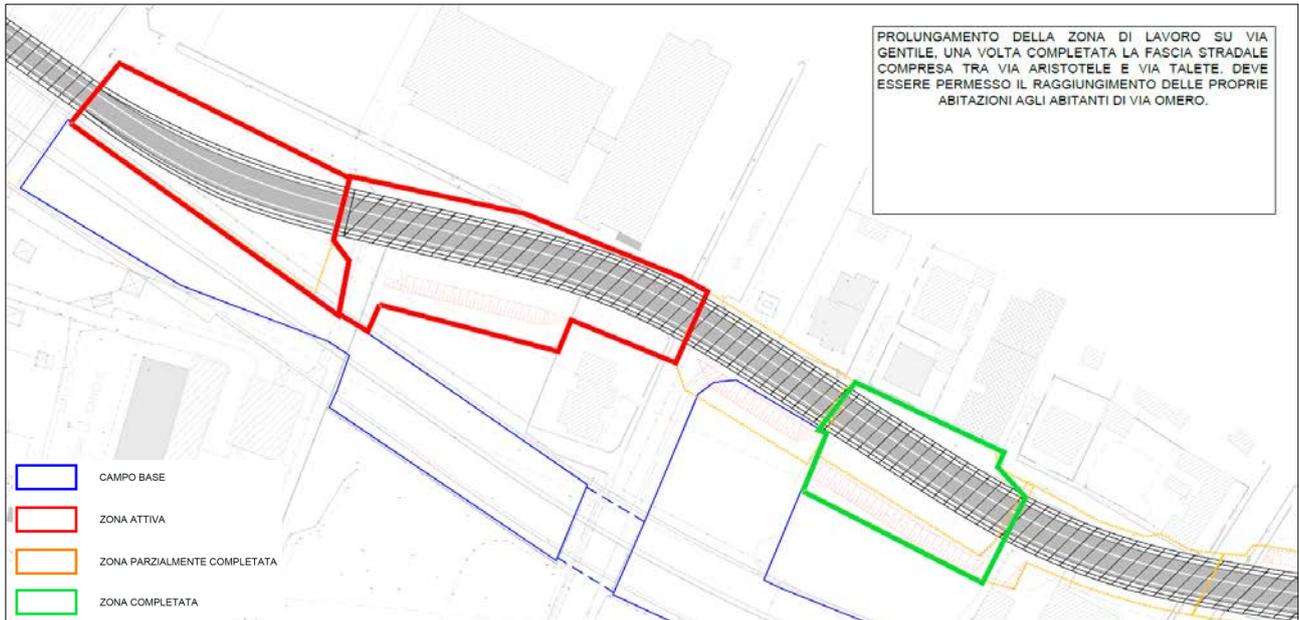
Fasi realizzazione copertura galleria del Piano di Sicurezza di progetto illustrativo della fase C di scavo della galleria
